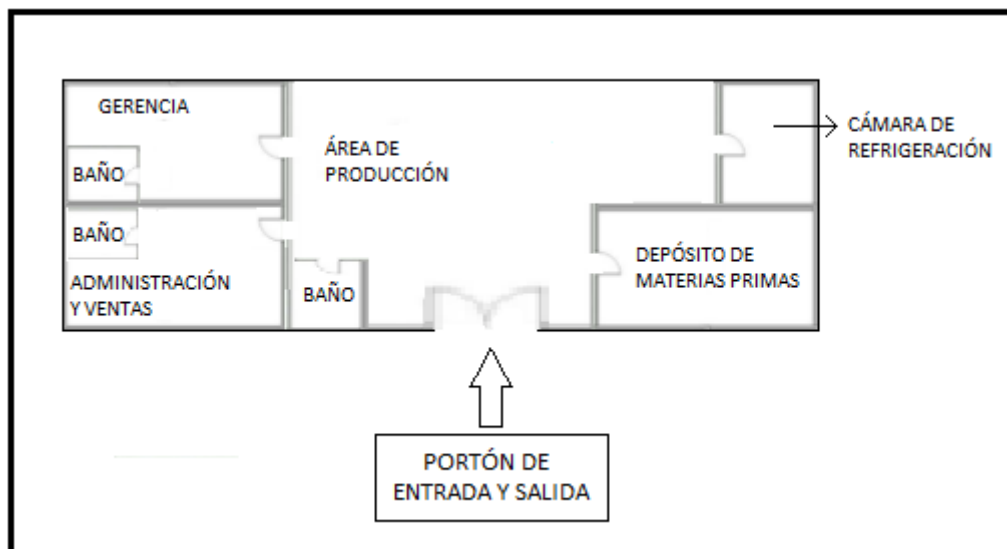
Plano de la planta (Fuente: *Elaboración propia*)
